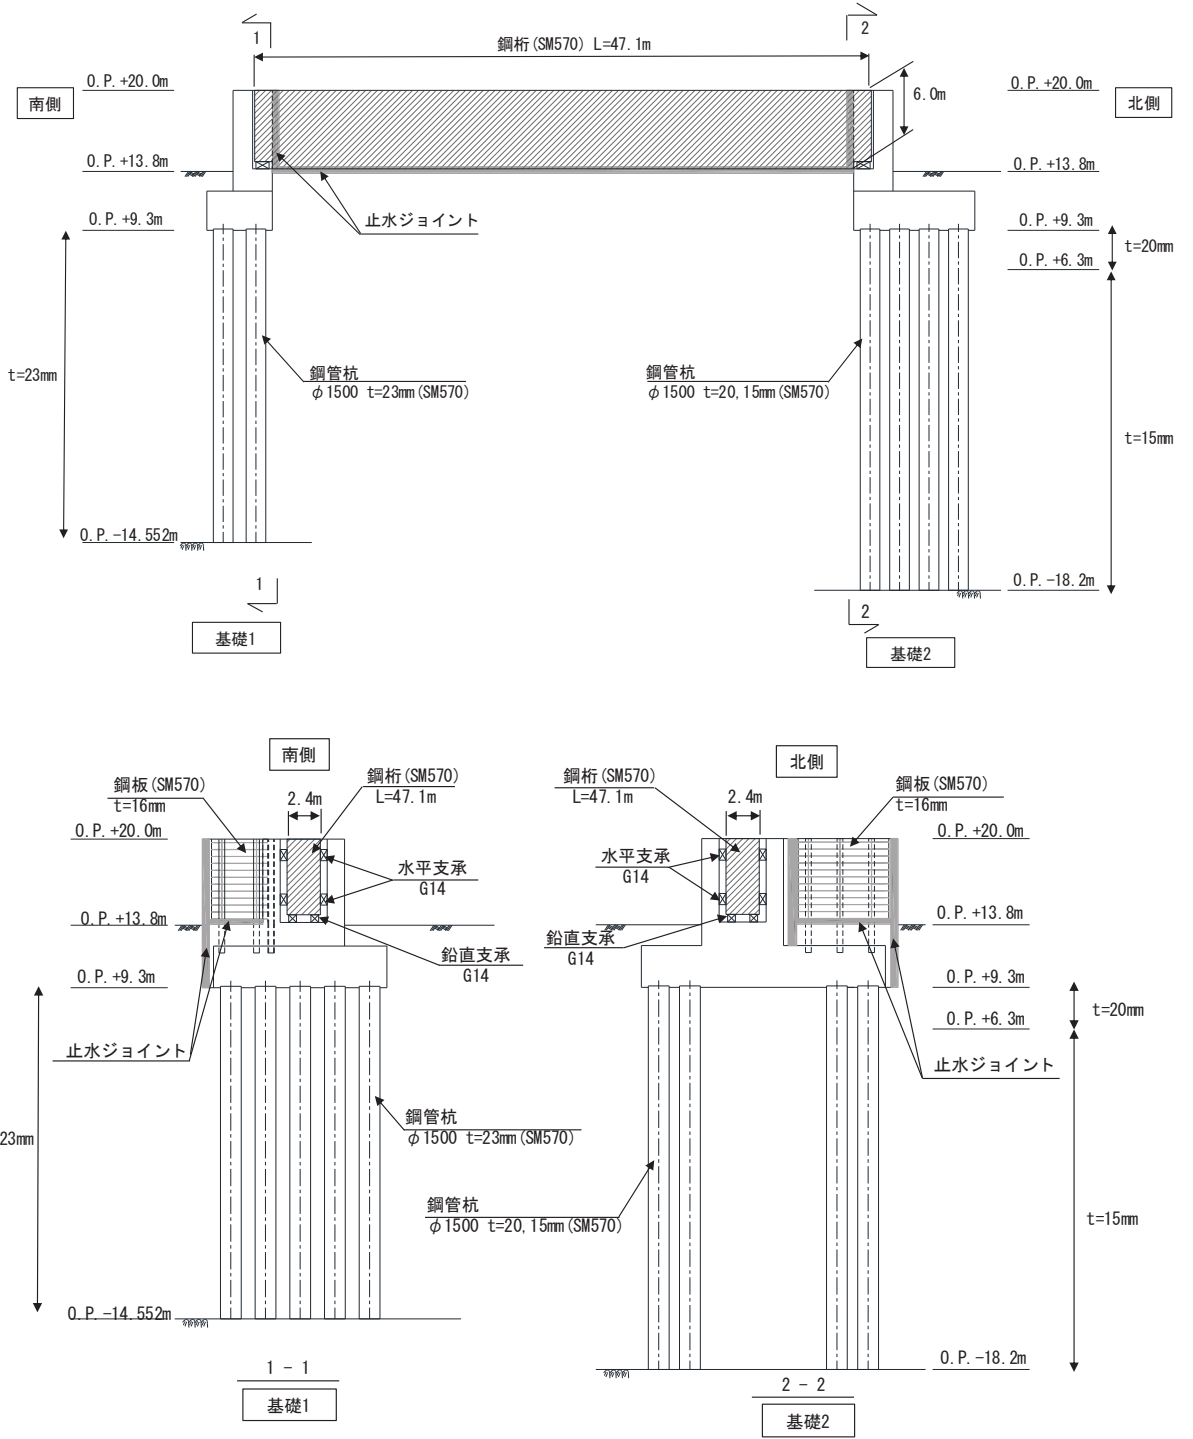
鋼製遮水壁 (鋼桁 4) 正面図及び断面図
